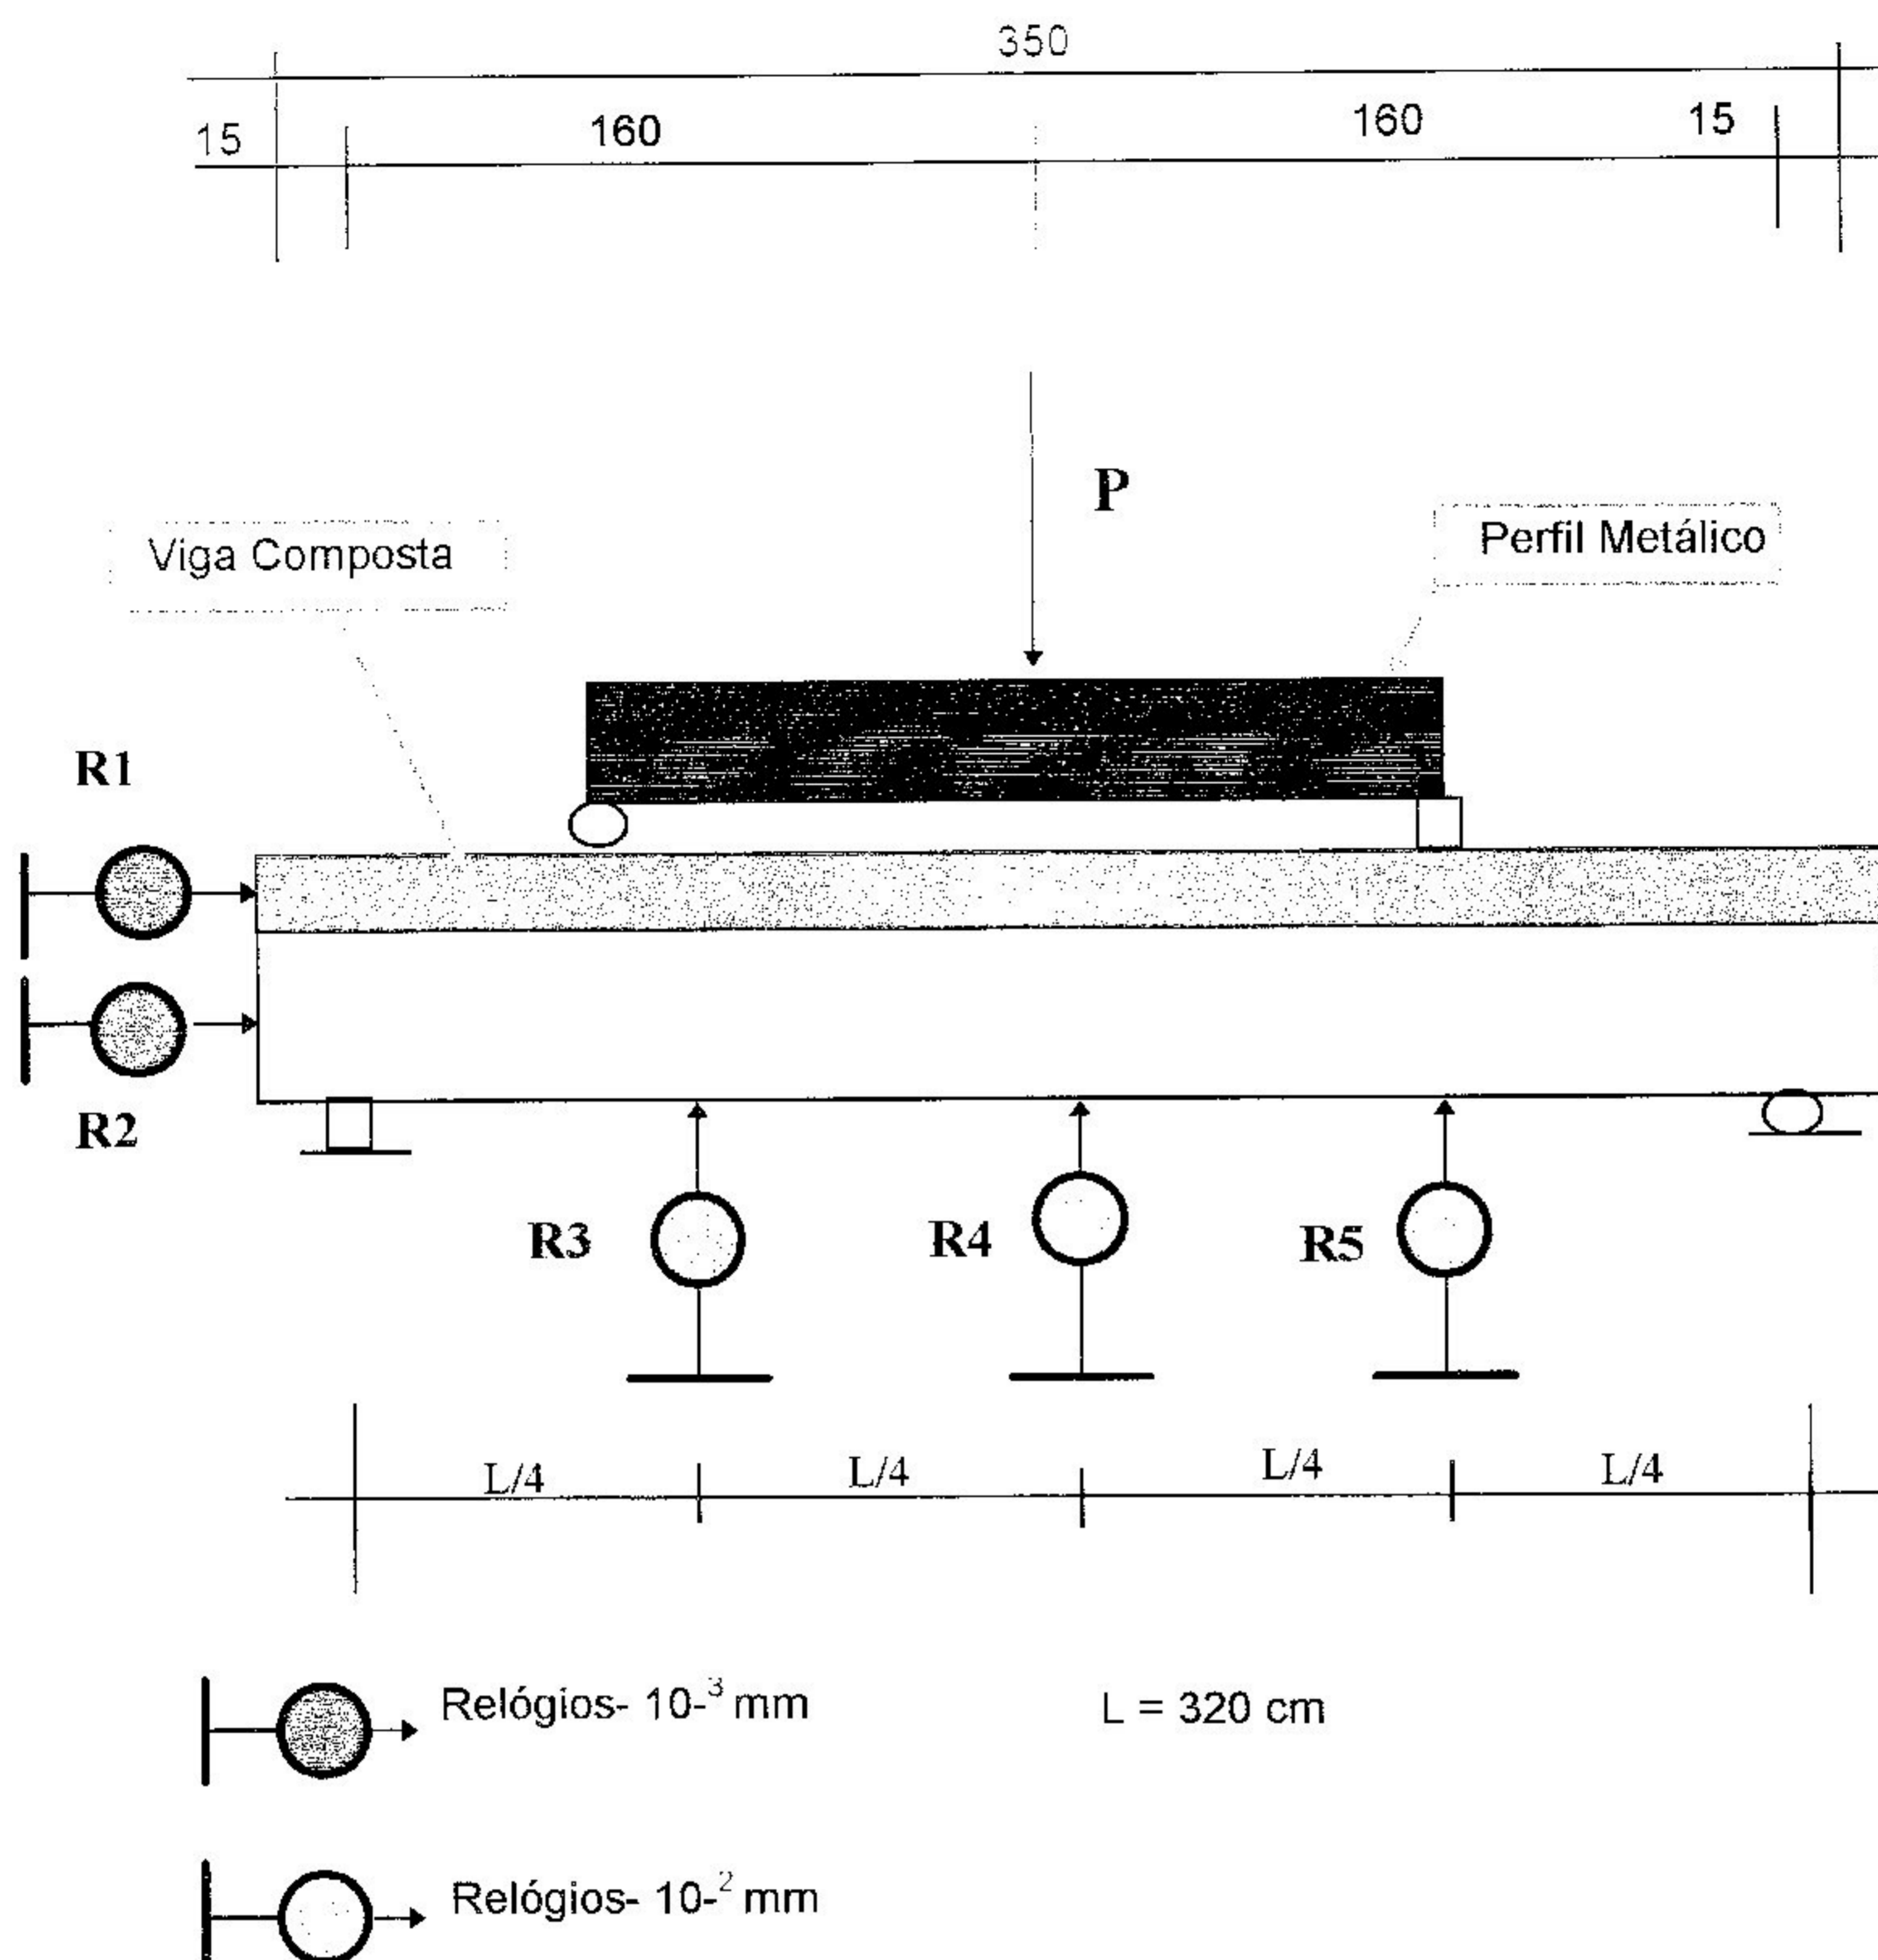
Esquema de Ensaio de Flexão da Viga Composta Madeira / Concreto (Protótipo 2)
